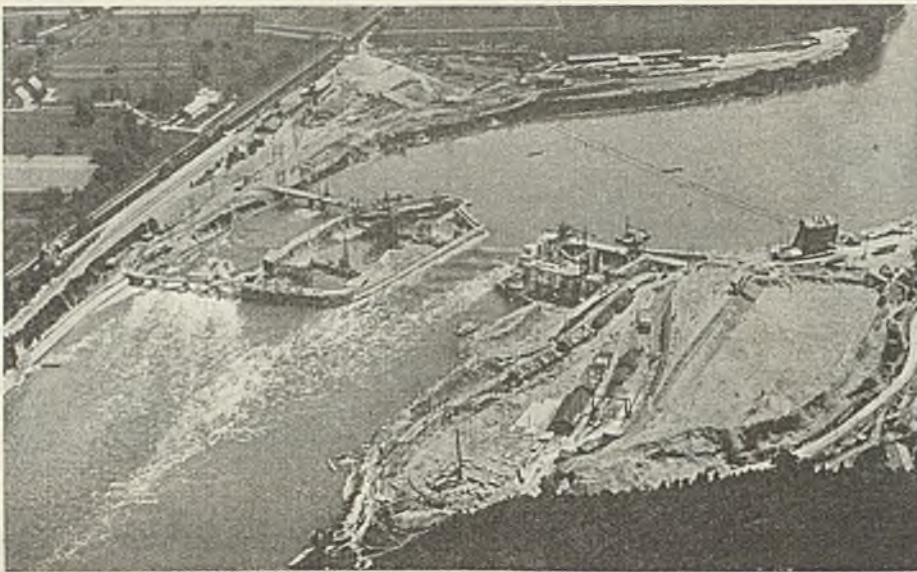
Luftbild der Baustelle vom 30. März 1928.
